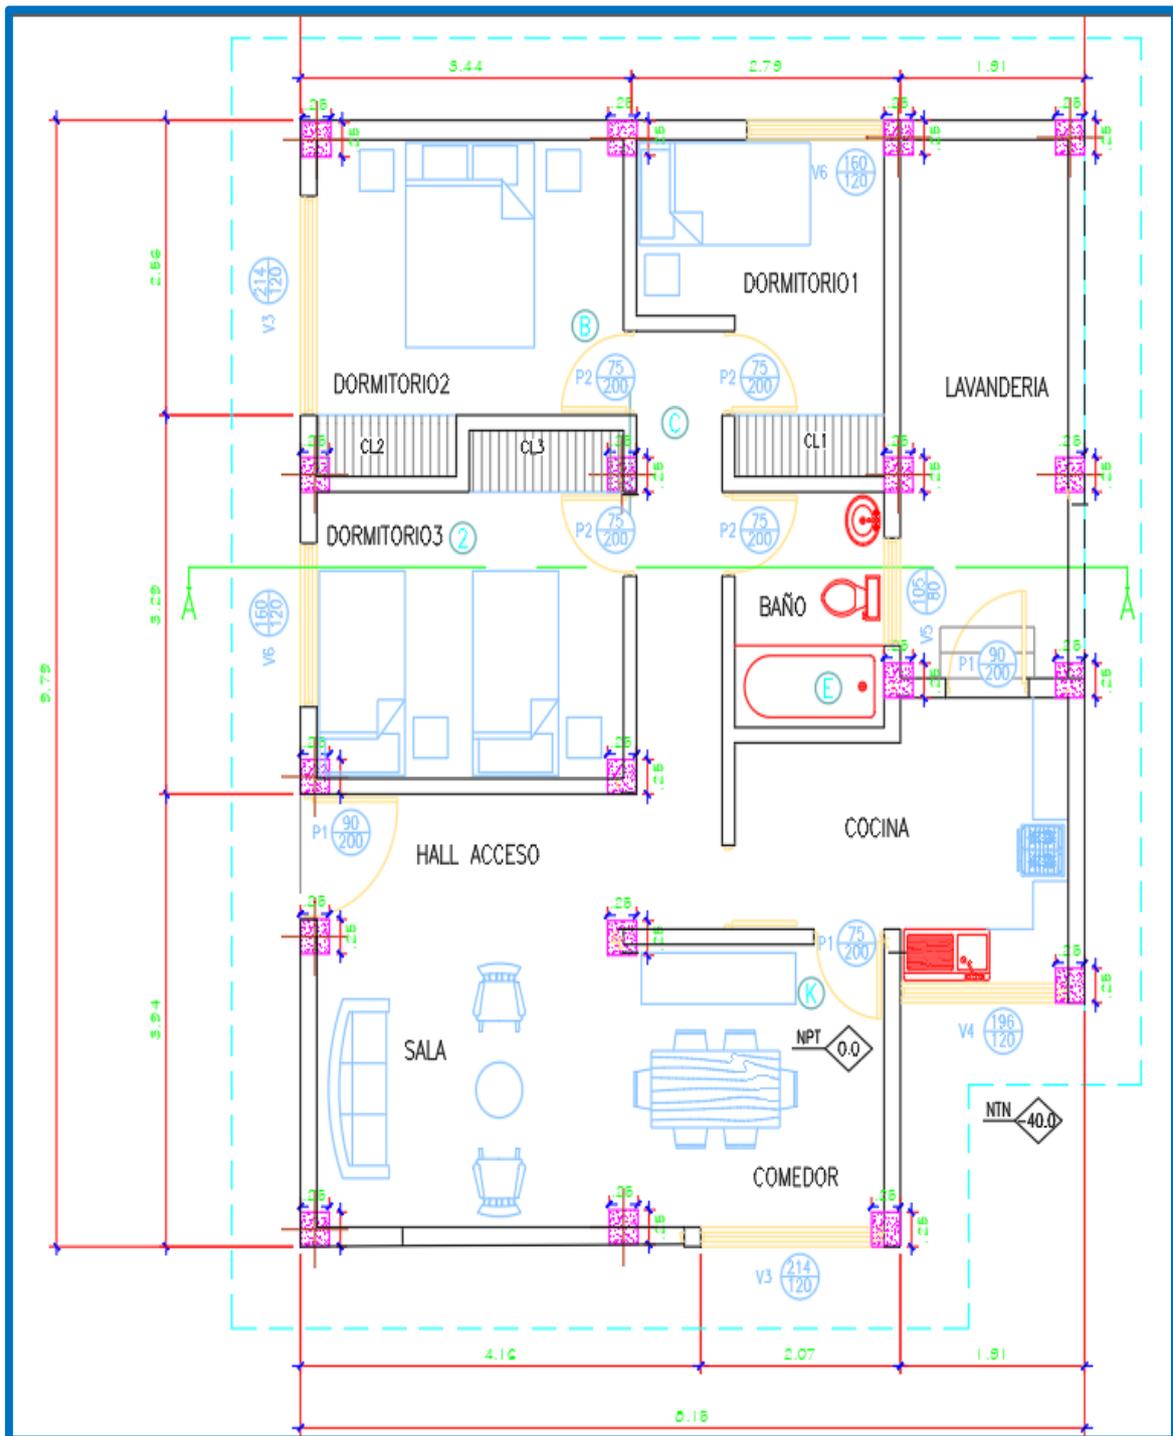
vista en planta de vivienda tradicional - Albañilería confinada
